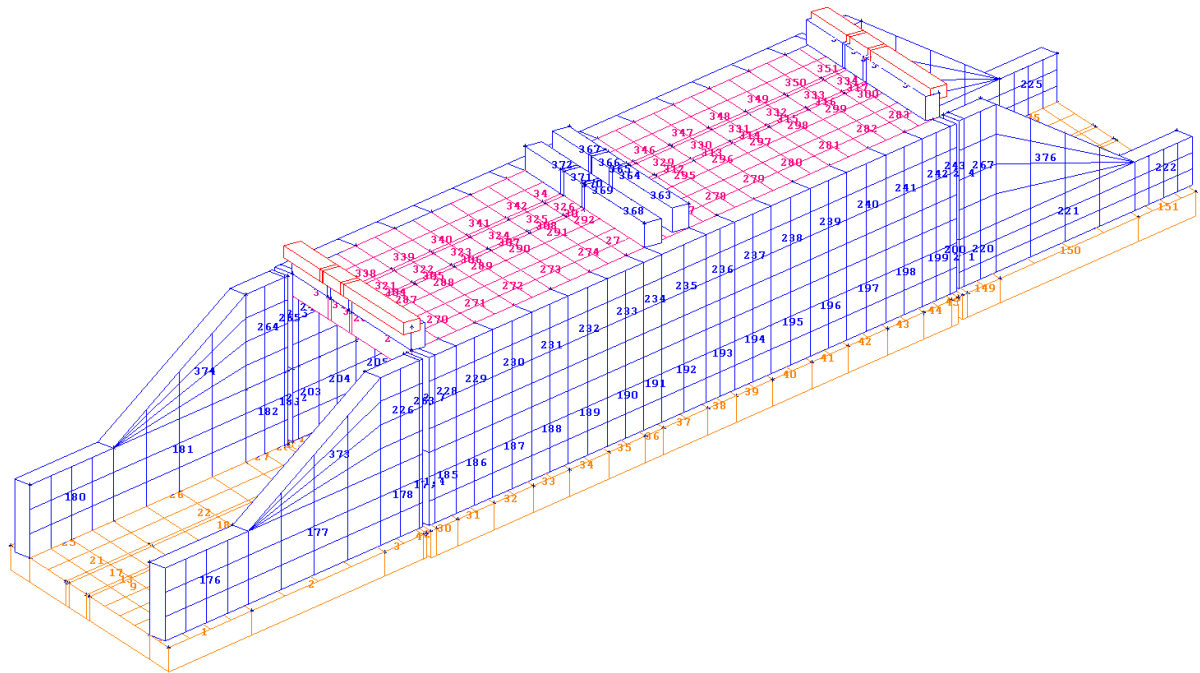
"Vista del modello di calcolo tridimensionale con indicazione del n.ro degli elementi tipo shell"
